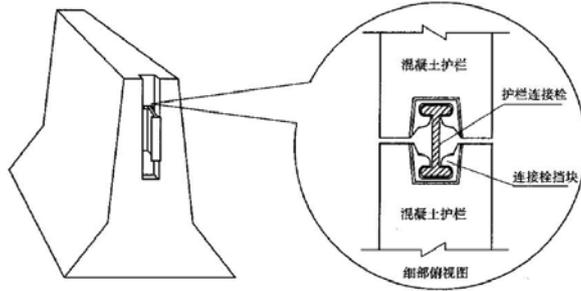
纵向栓接连接（尺寸单位：mm）
